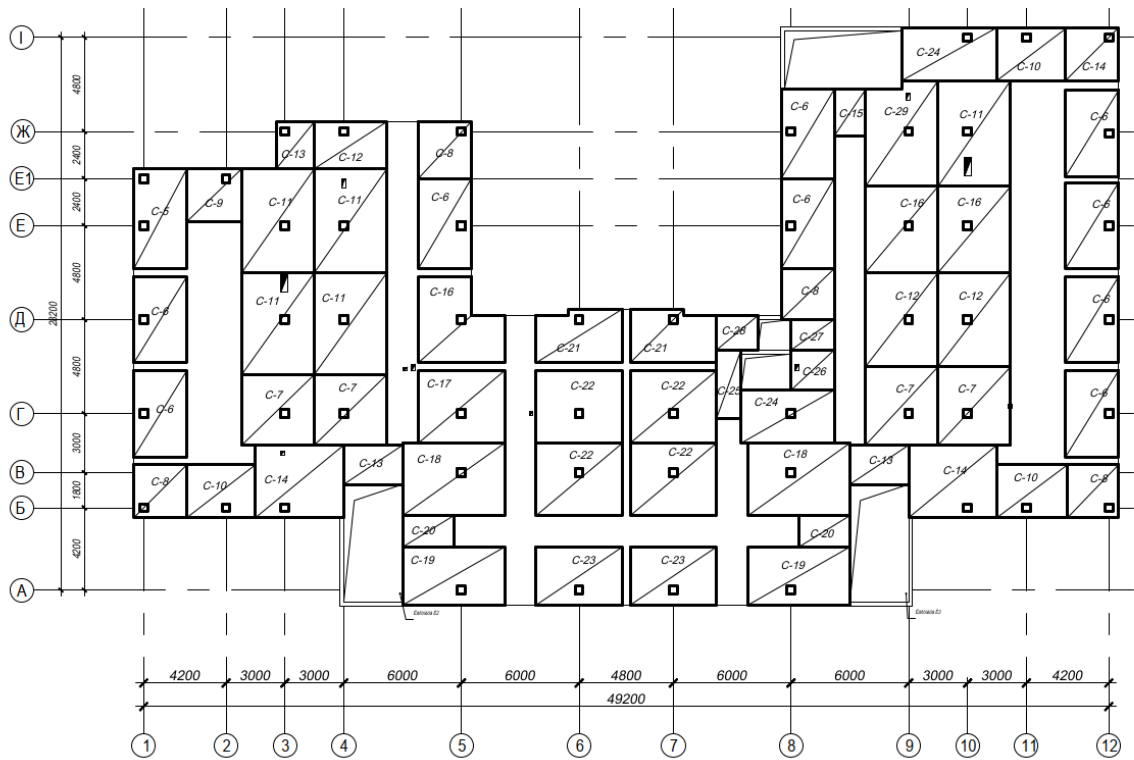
Схема розташування верхньої арматури монолітної плити
